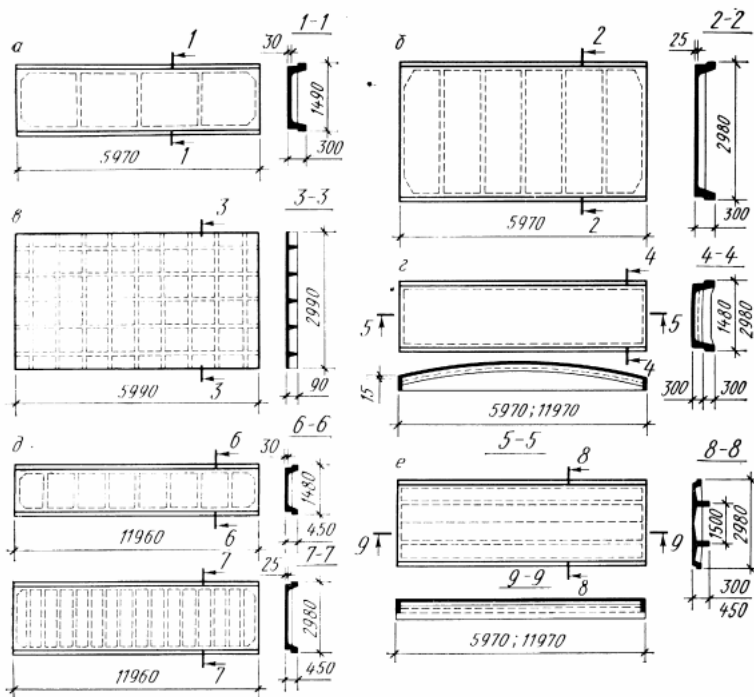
Великорозмірні залізобетонні панелі покриттів:
